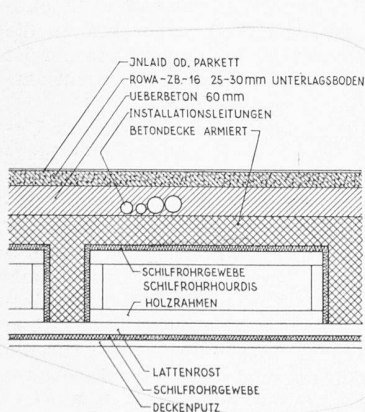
Schilfrohrhohlkörperdecke im Flughafen Zürich-Kloten, Schnitt 1:15
